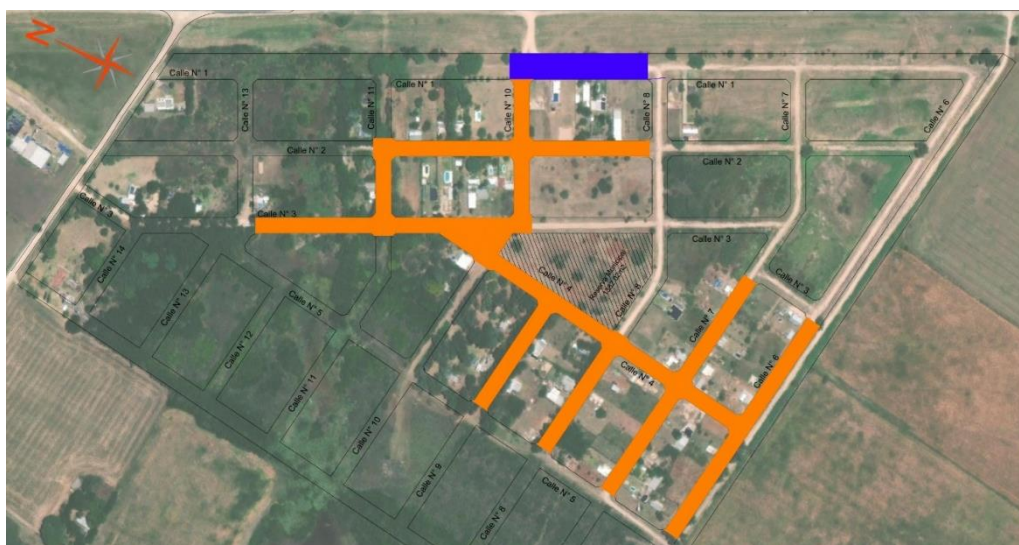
Ubicación de calles de 8 metros de ancho (anaranjado) y 12 metros de ancho (azul).
